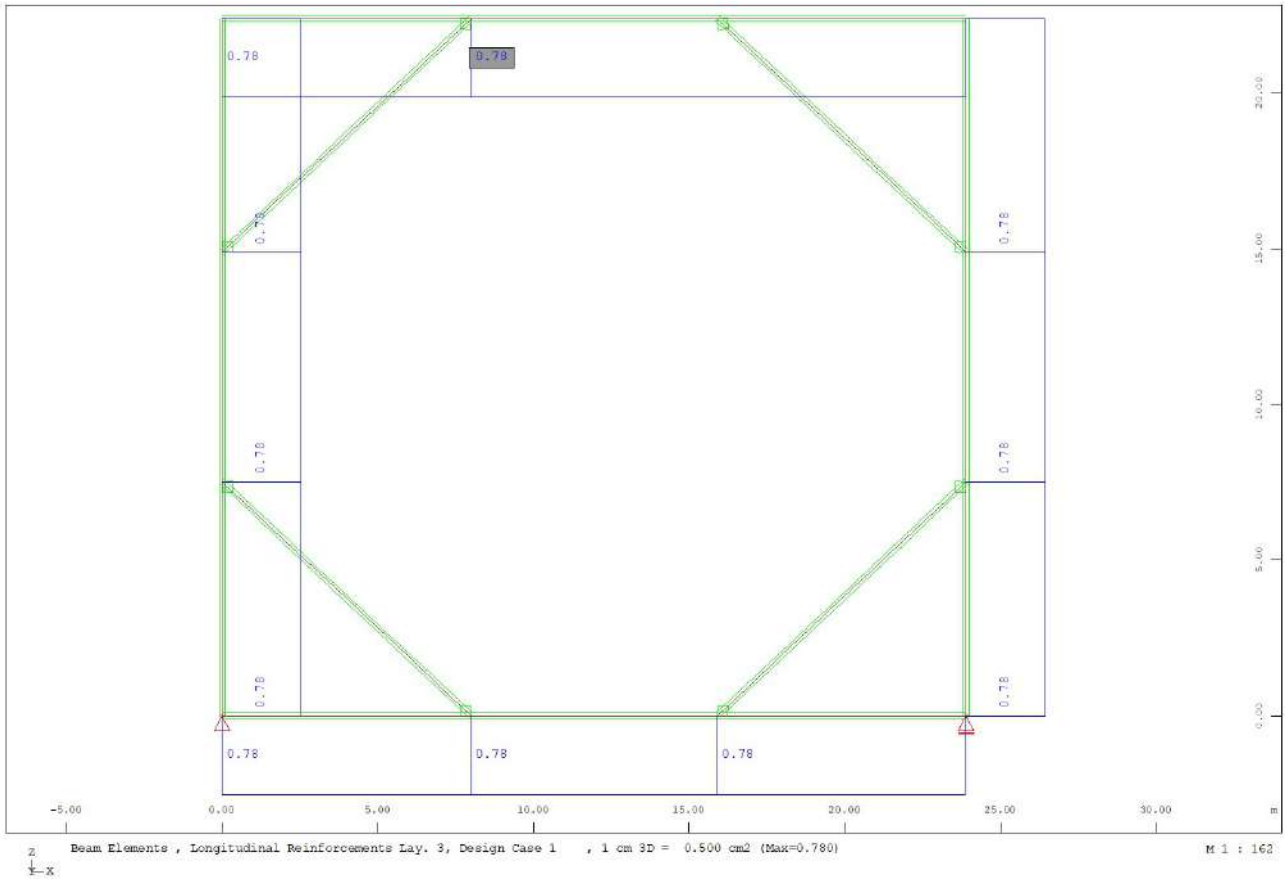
Armatura longitudinale superiore/ inferiore
